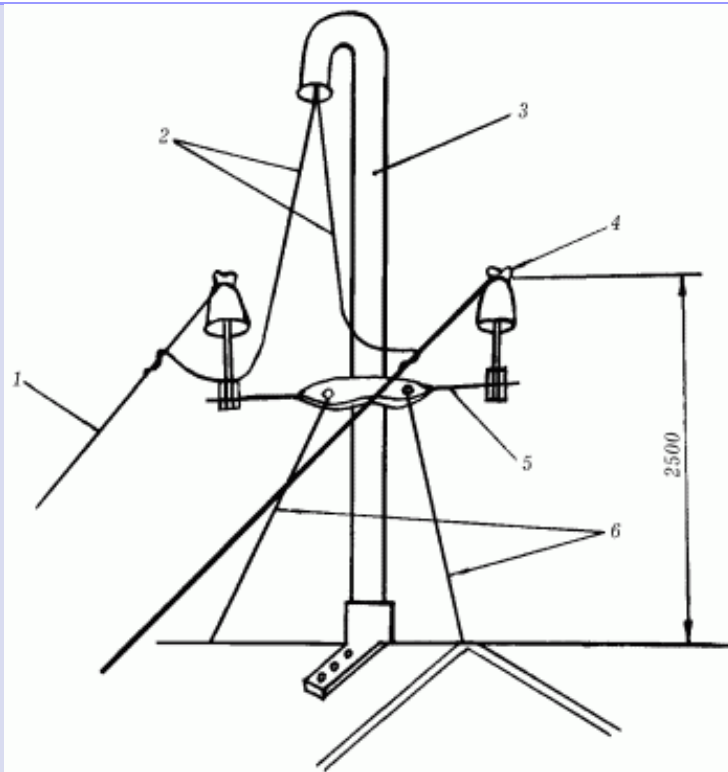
Ввод провода ВЛ в здание трубостойкой через крышу: 1 – провод ВЛ; 2 – провода ввода в здание; 3 – труба стальная; 4 – изоляторы концевые; 5 – траверса; 6 – растяжки.
